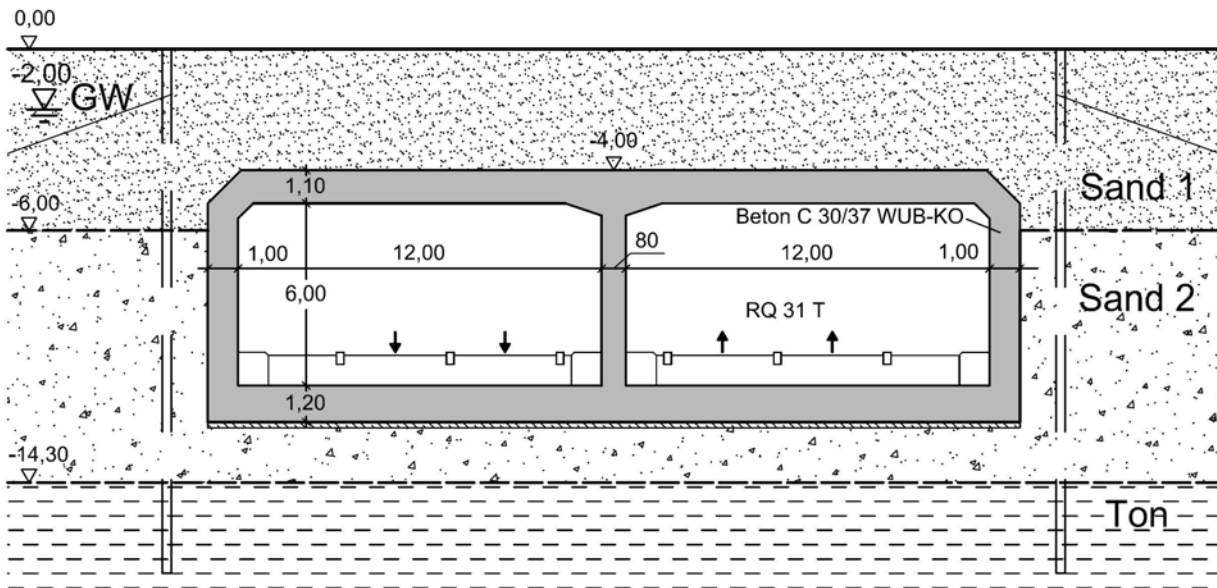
Tunnel in offener Bauweise, Querschnitt Endzustand
